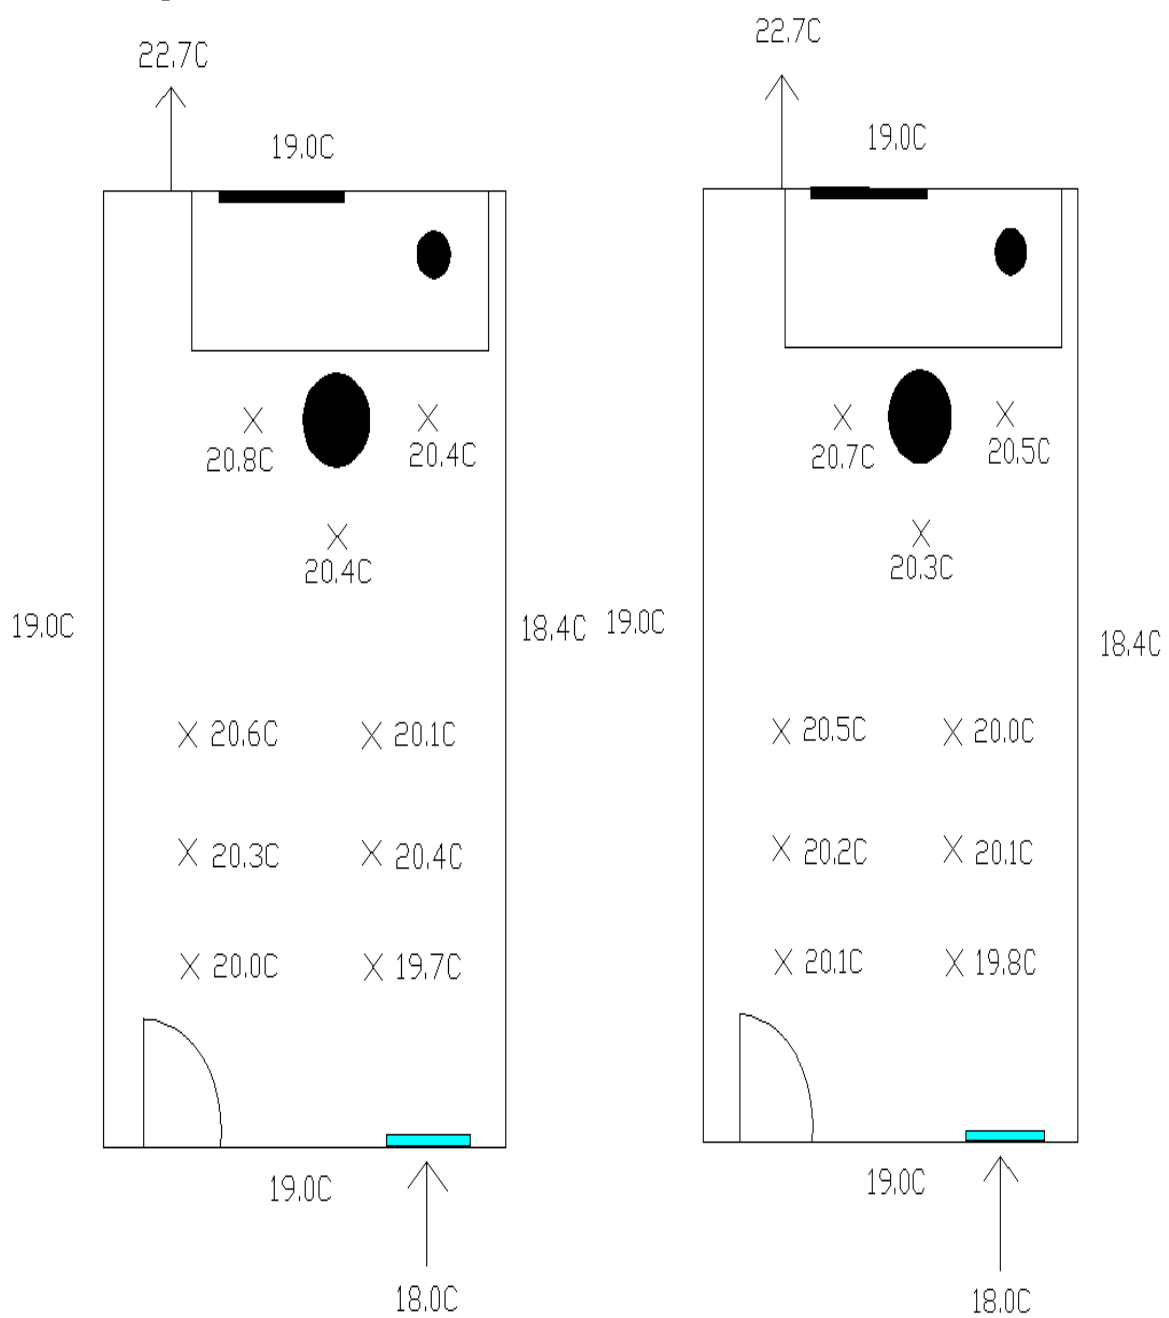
Til venstre: 5cm over gulvet. Til høyre: 10cm over gulvet.
